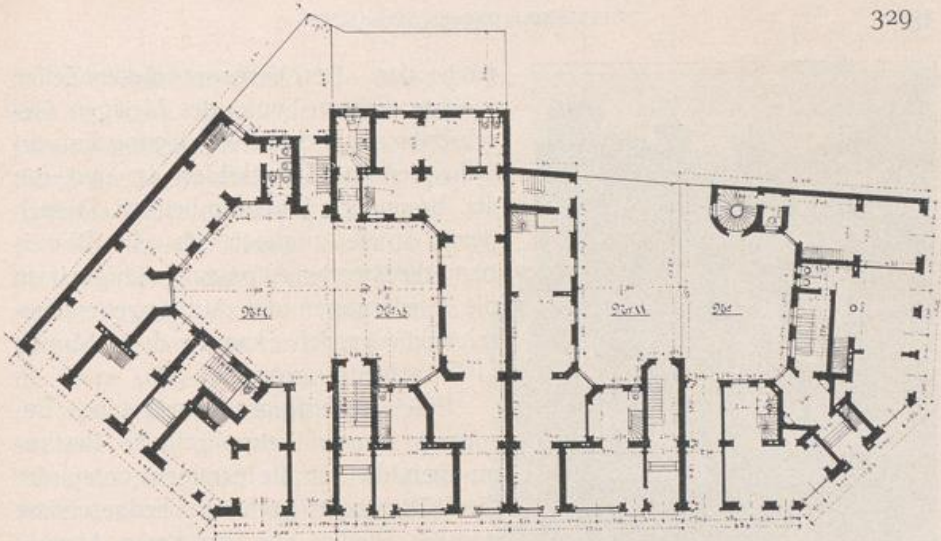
Ecke Königsallee, Graf-Adolf- und Hüttenstrasse. Erdgeschoss. 1:500.
